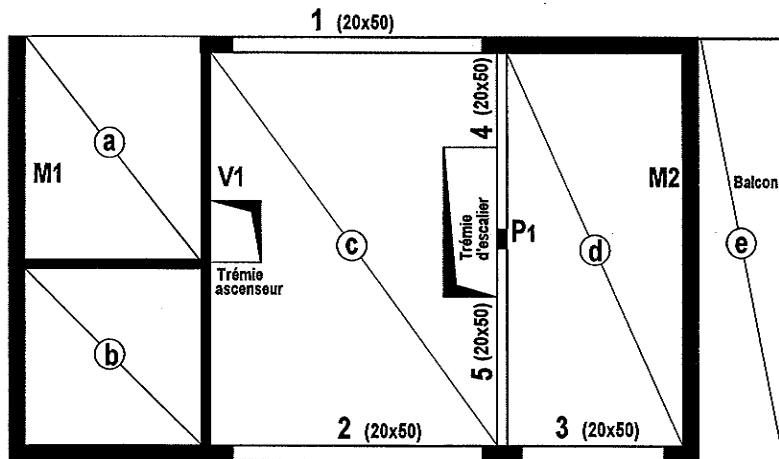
Structure porteuse : fondations + (murs, voiles, poteaux) + poutres.
